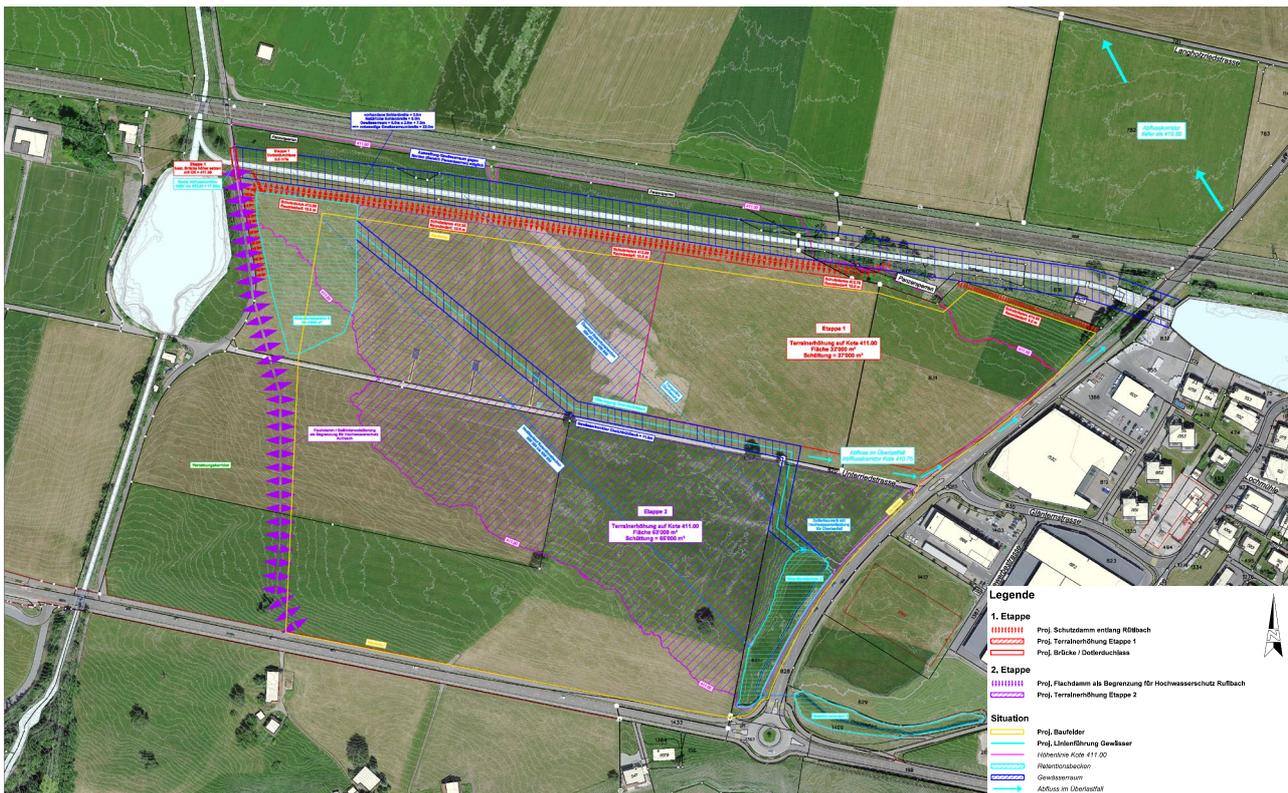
Vorprojekt Hochwasserschutz Rietli mit bestehenden Retentionsbecken und geplanten Terrinaufschüttungen, Marty Ingenieure 2022
